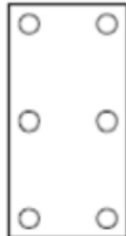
plans de chevillage – panneaux de dimensions 1000 x 500 mm
